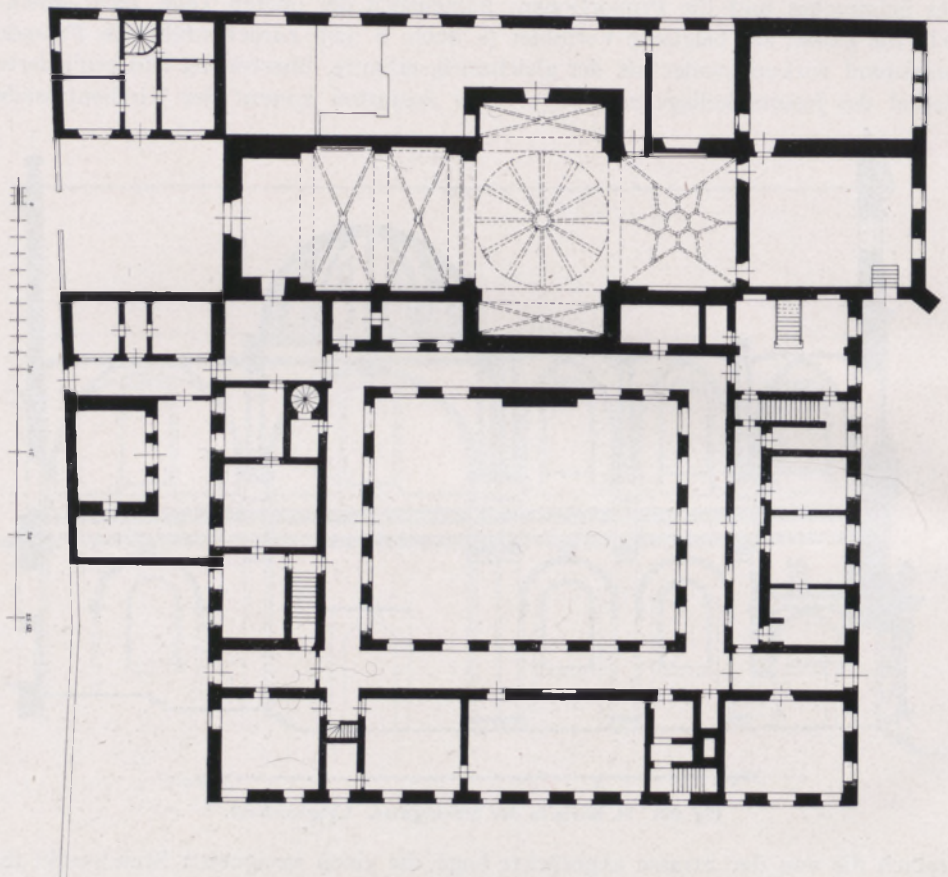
St. Maria in der Schnurgasse. Grundriss des ehem. Klosters (nach einem Plan vom Anf. d. 19. Jh.).
